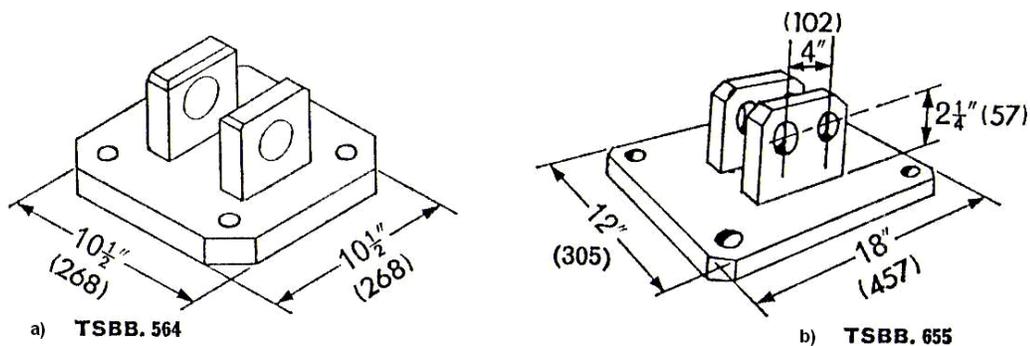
Zapatas de Pilas Bailey (TSBB.564 y TSBB.655).
